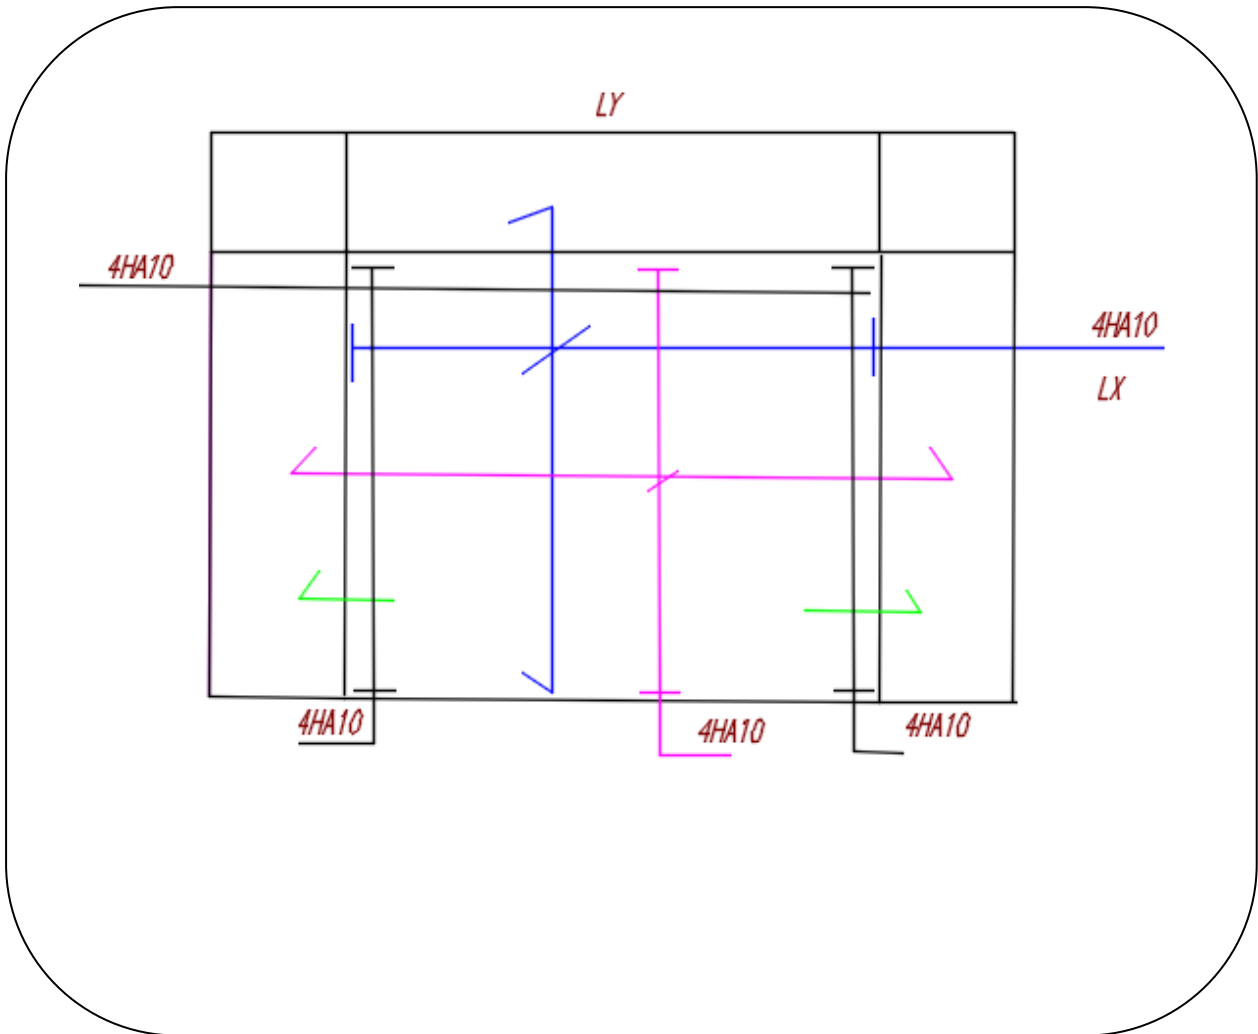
Schéma de ferrailage du balcon trois appuis.
